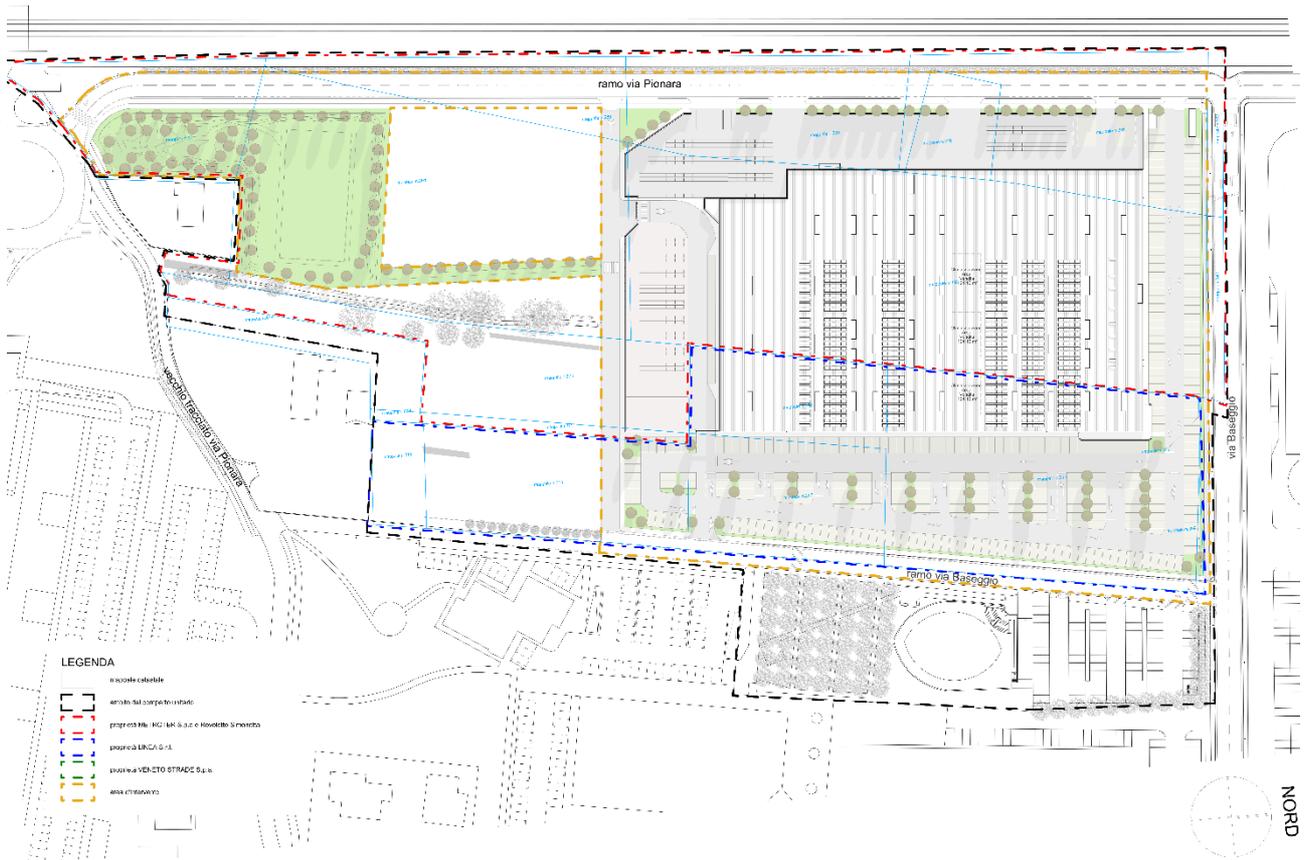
Rappresentazione planivolumetrica del progetto (Fonte: Planivolumetrico e dati urbanistici – AI Progetti)
